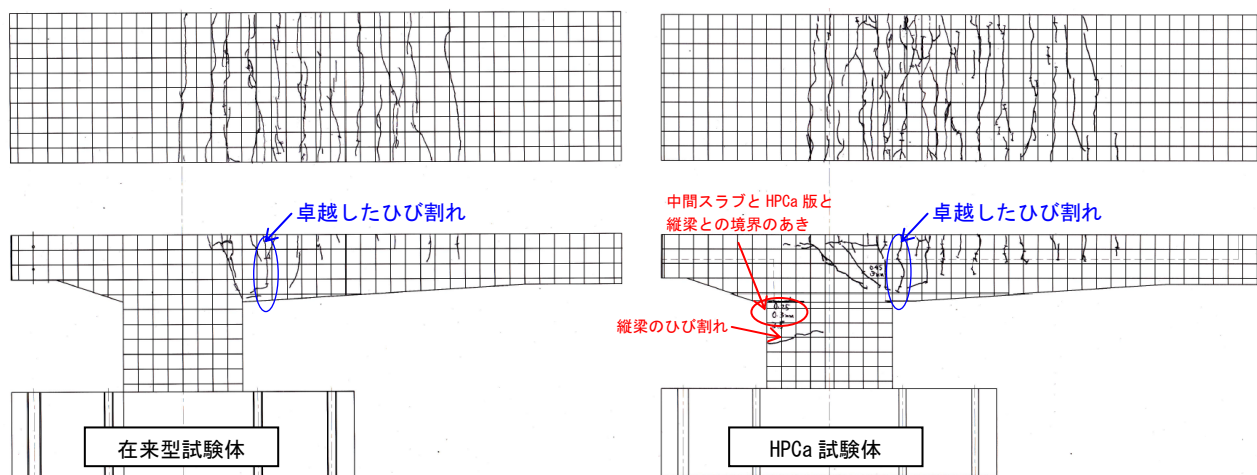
構造性能確認試験終了時(載荷点変位 90mm)のひび割れ状況図
